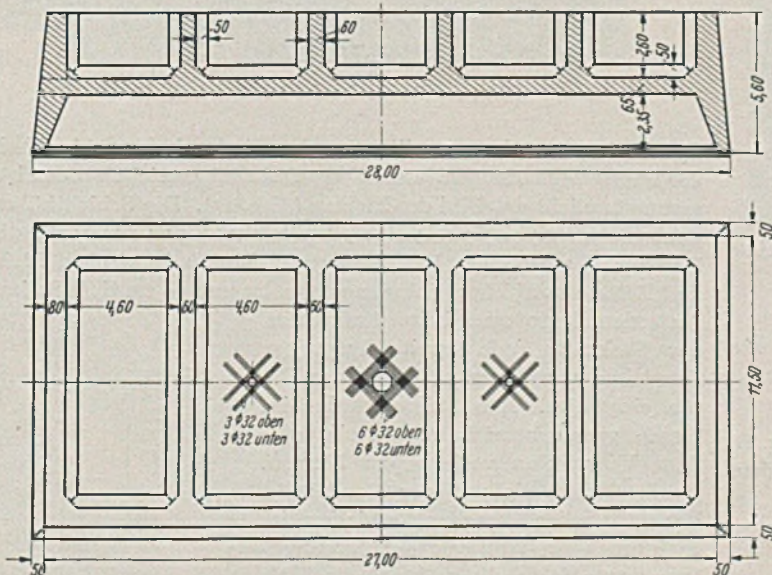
Längsschnitt und Grundriß des Senkkastens.
